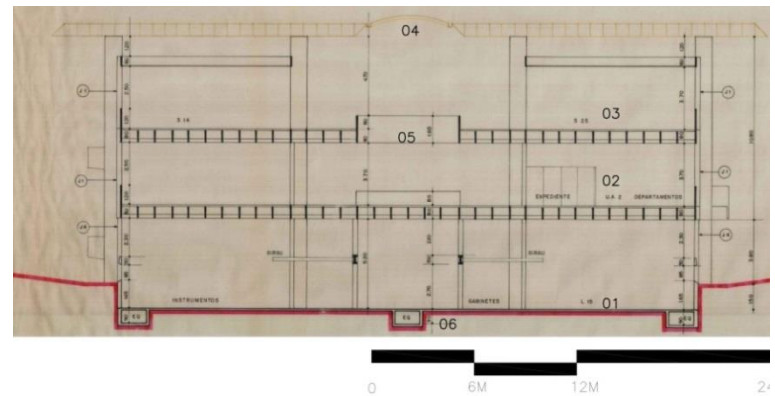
Corte B - Bloco Didático Plano UMA. Fonte: Prancha 15 do Plano de Implantação Imediata – 1º Sub-Etapa Plano UMA – Arquivo digital disponível no COMCAP-UEM.
